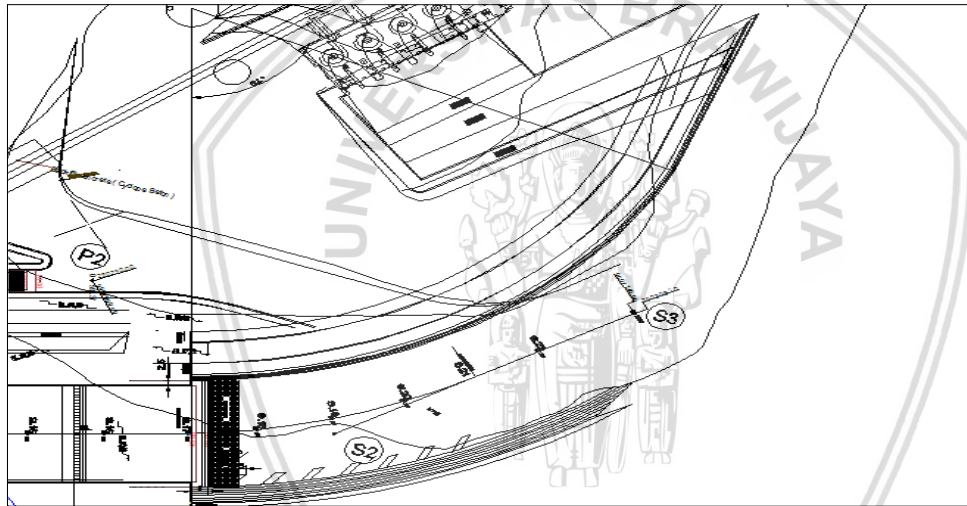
Potongan memanjang penambahan sill pada saluran transisi
